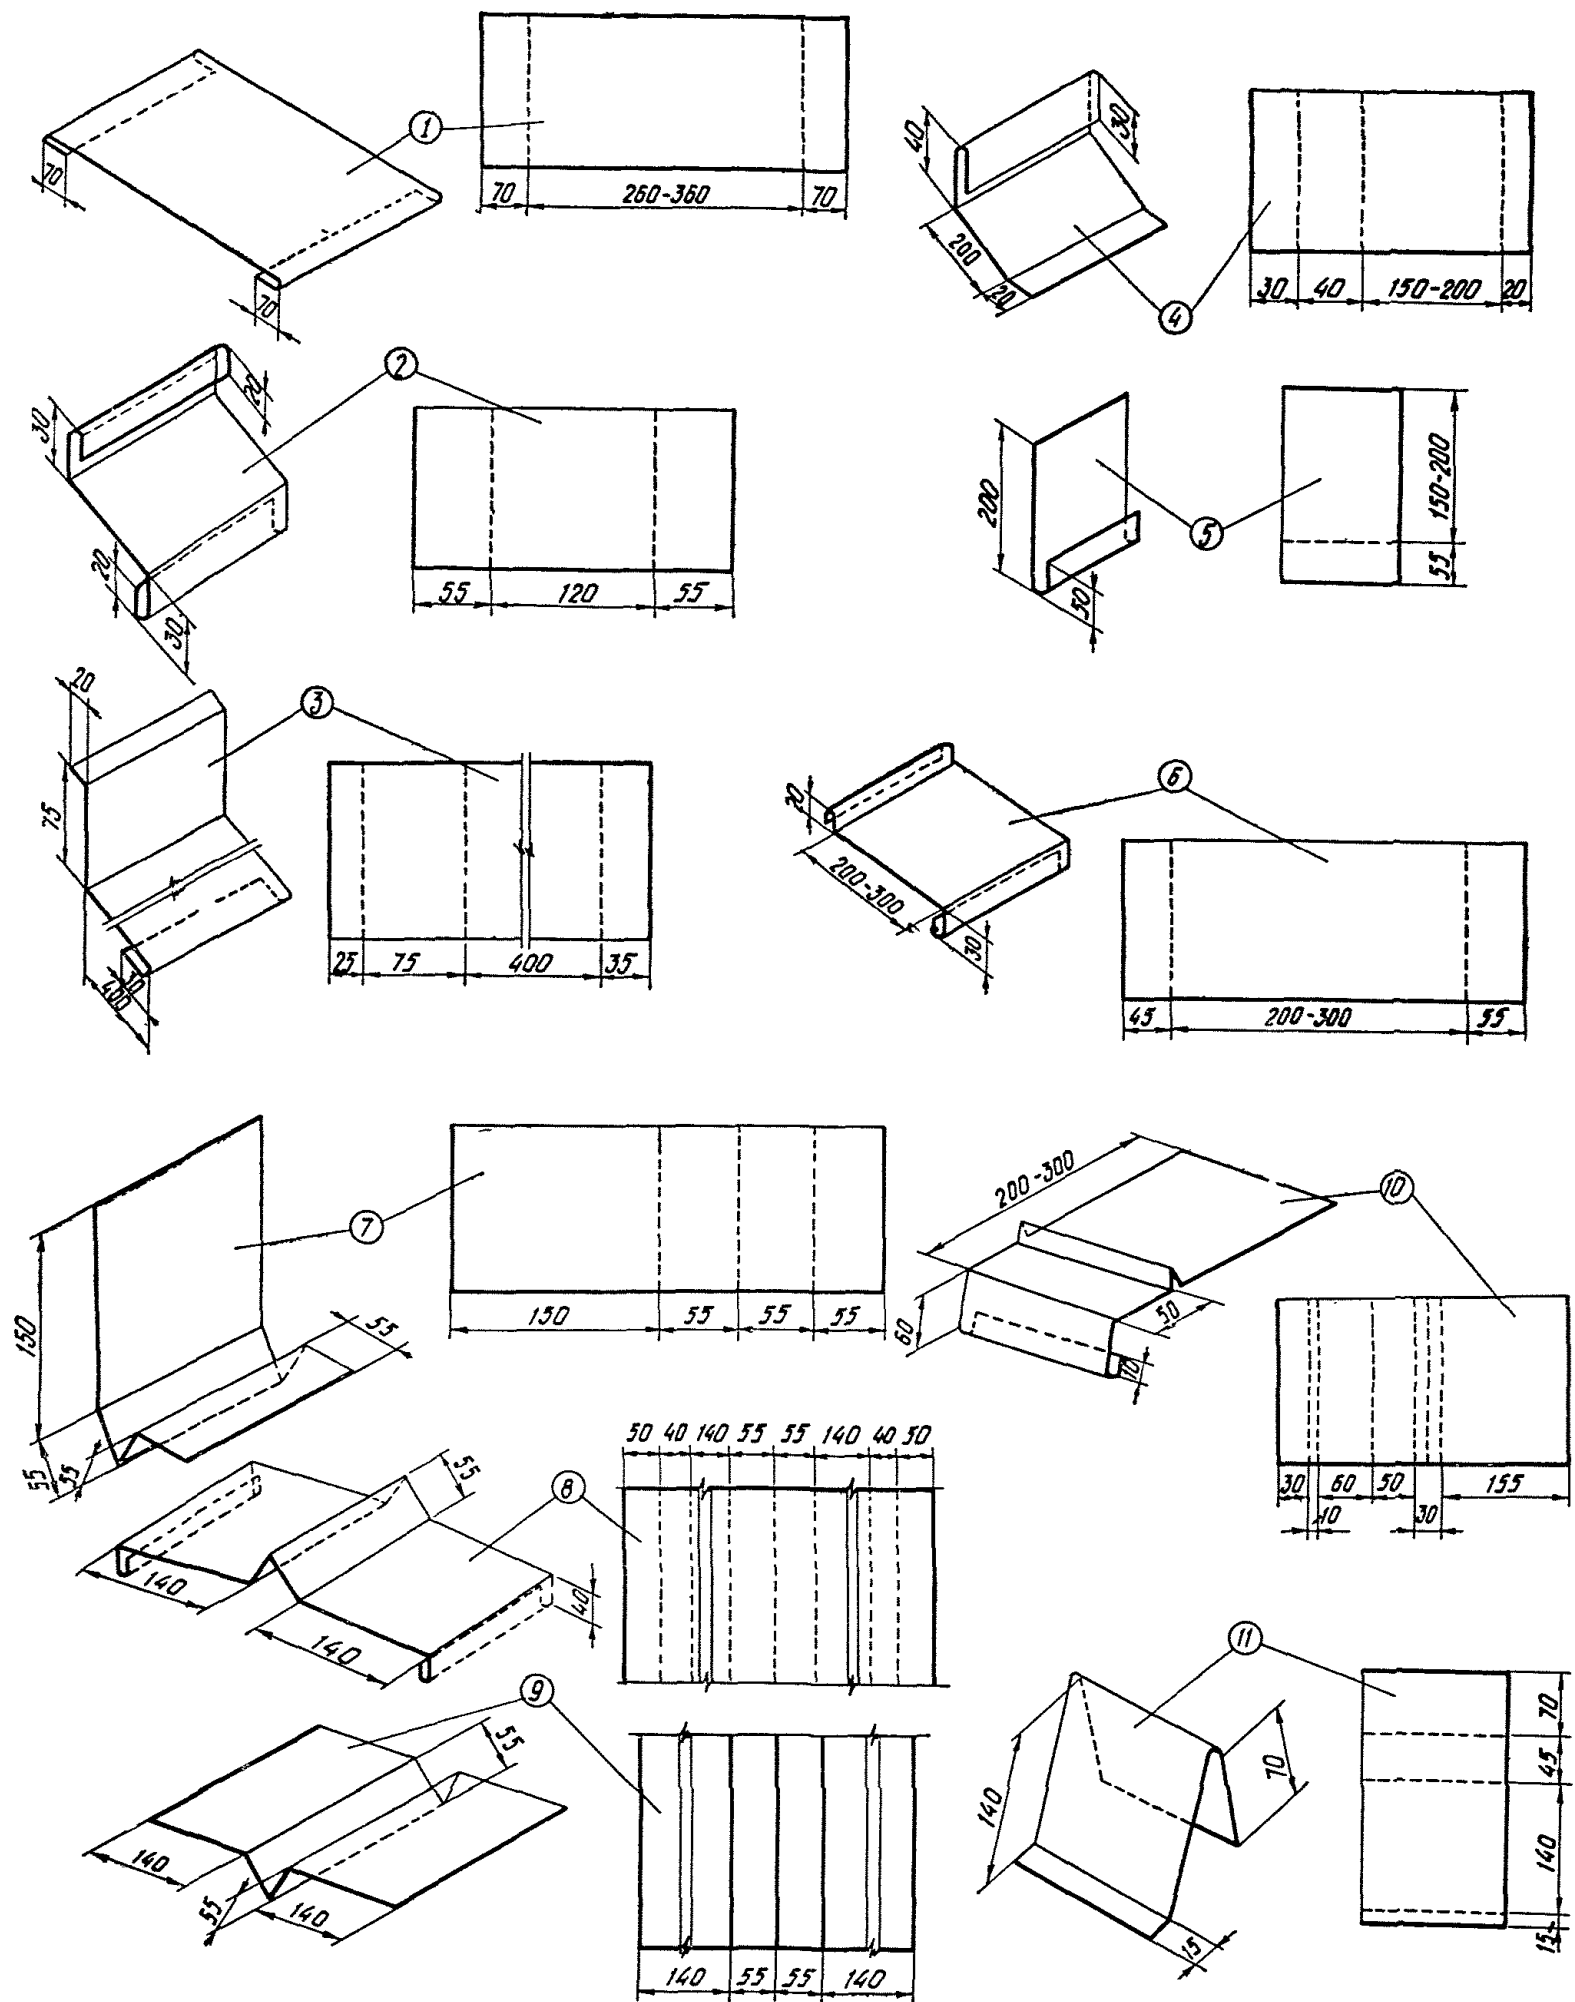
Фасонные элементы из кровельной оцинкованной стали
